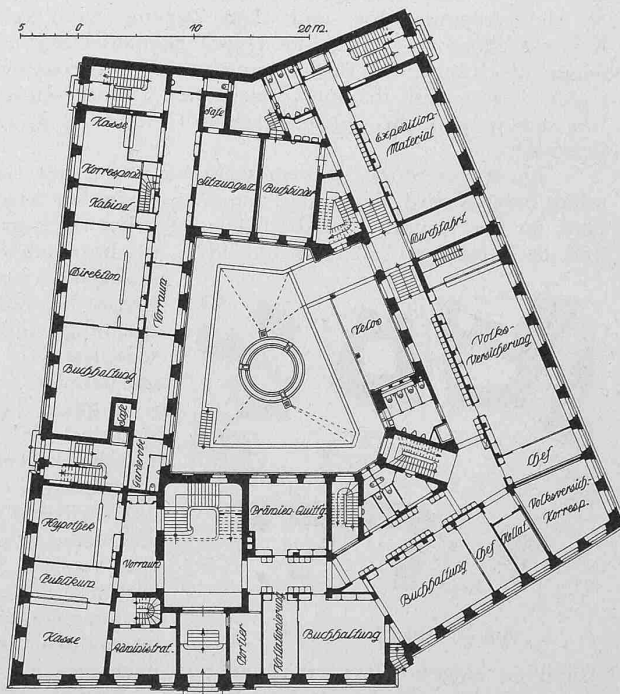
Grundriss vom Erdgeschoss. — 1:600.
